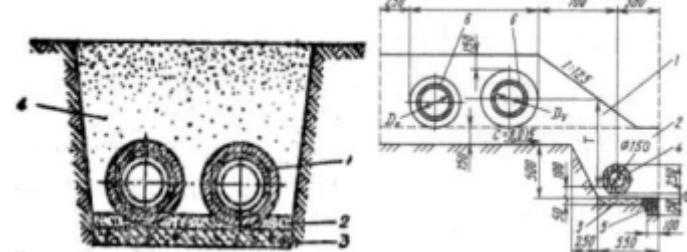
Прокладання безканальних трубопроводів в глинистих ґрунтах:
